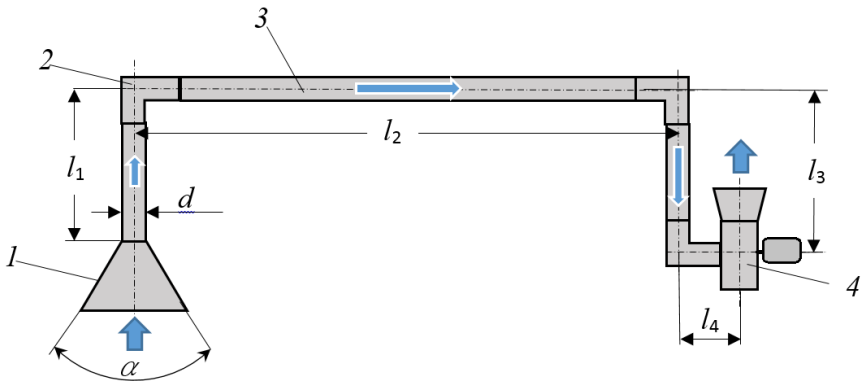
Схема механічної вентиляції: 1 – розтруб-конфузор; 2 – коліно без закруглення; 3 – повітропровід; 4 – радіальний (відцентровий) вентилятор.
